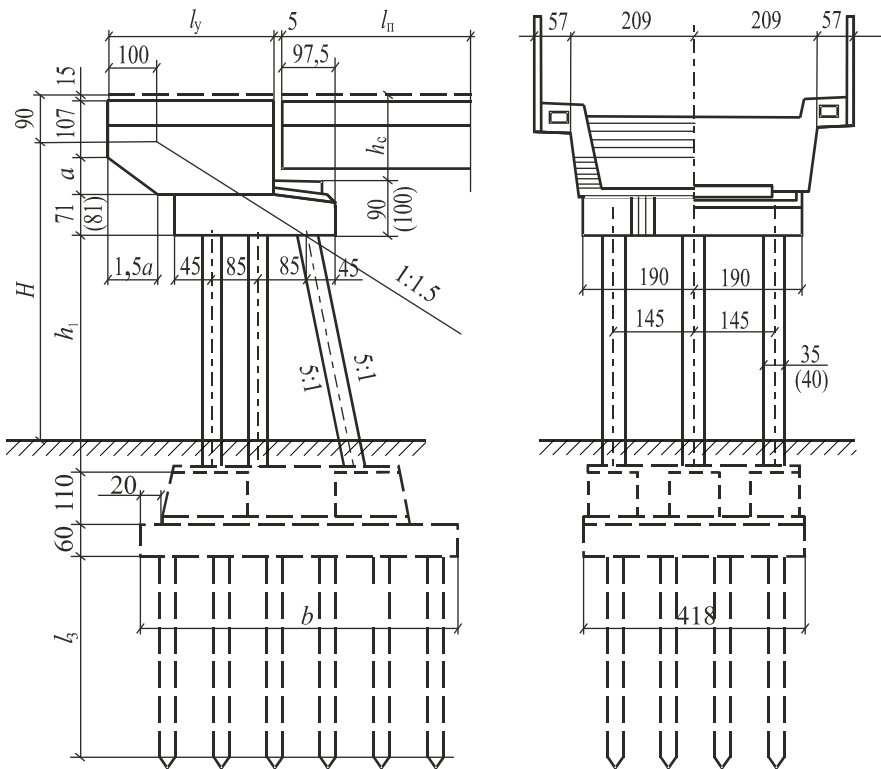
Схема устоя с вариантом свайного фундамента
